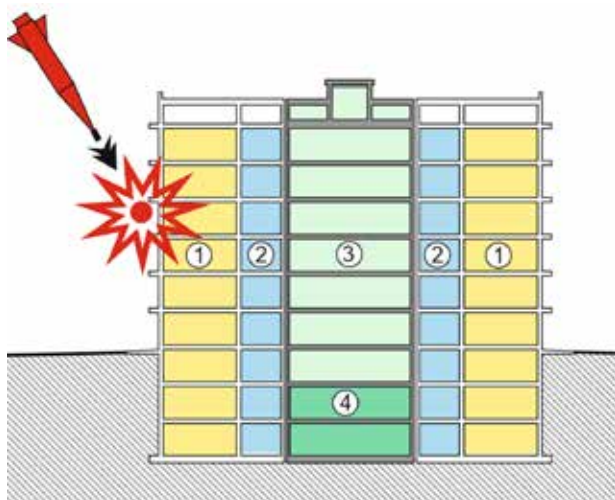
Схема руйнування п'яти прогонувої будівлі лікарні: 1 – кабінети, палати, 2 – коридор; 3 – операційні; реанімаційні, пологові, укриття на поверсі 4 – підземне сховище
